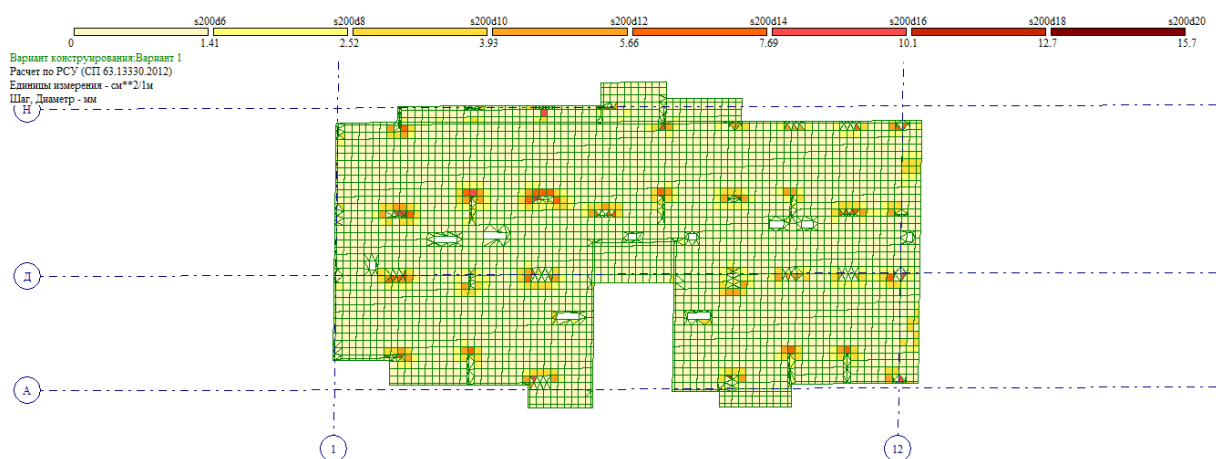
Верхнее армирование плиты по оси X1
